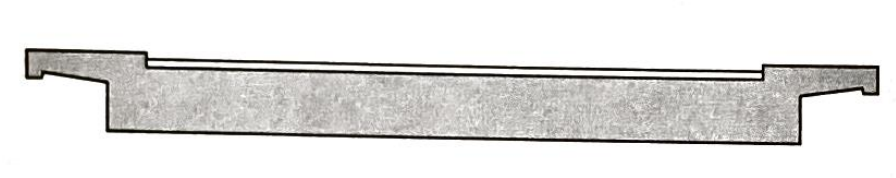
Querschnitt einer Plattenbrücke²⁰⁵
